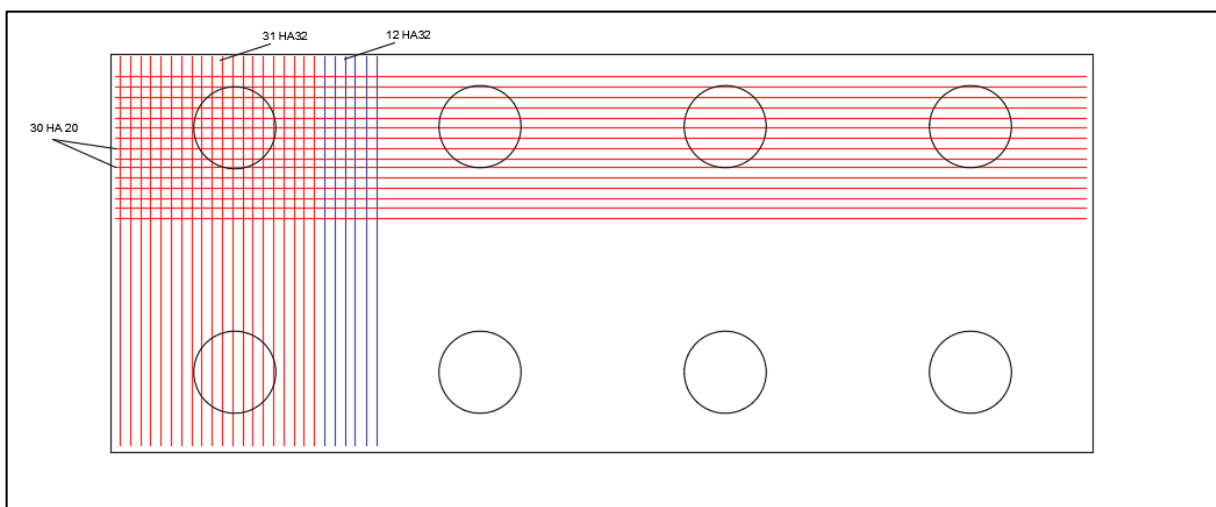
Ferrailage de la semelle (nappe inférieure)
